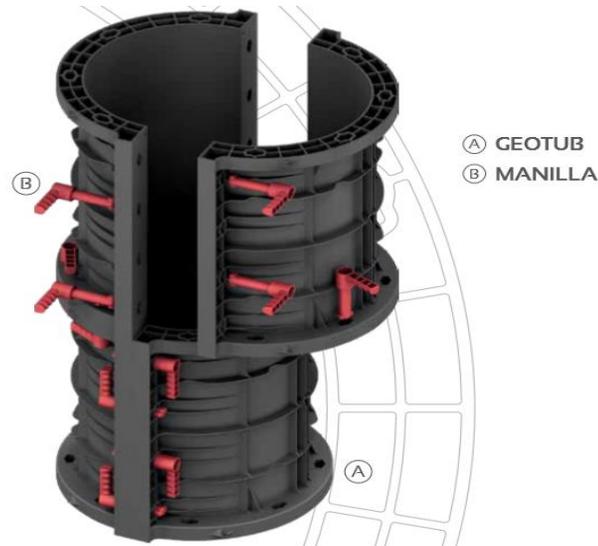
Dimensiones encofrado plástico en columnas circulares
